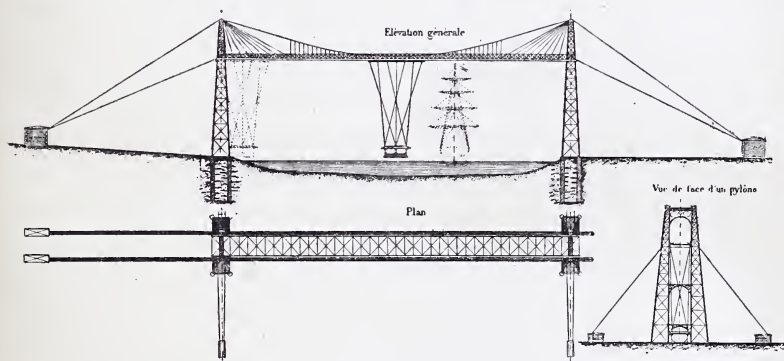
Élévation, plan et vue en bout du pont à transbordeur.
